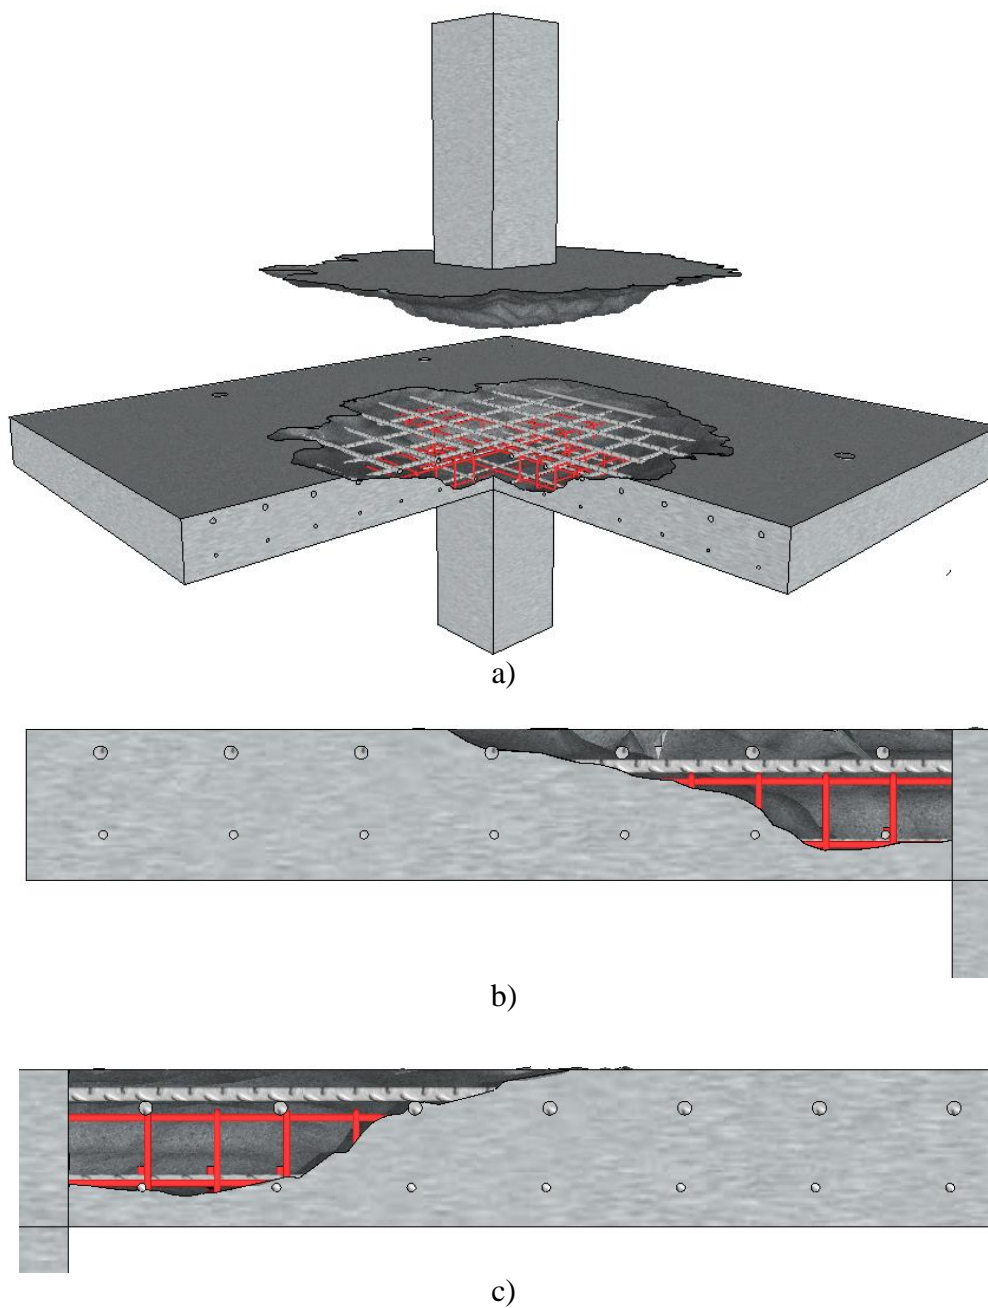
Superfície de ruptura e cone de punção da laje FS-2; b) Corte e superfície de ruptura do lado leste; c) Corte e superfície de ruptura do lado norte.
